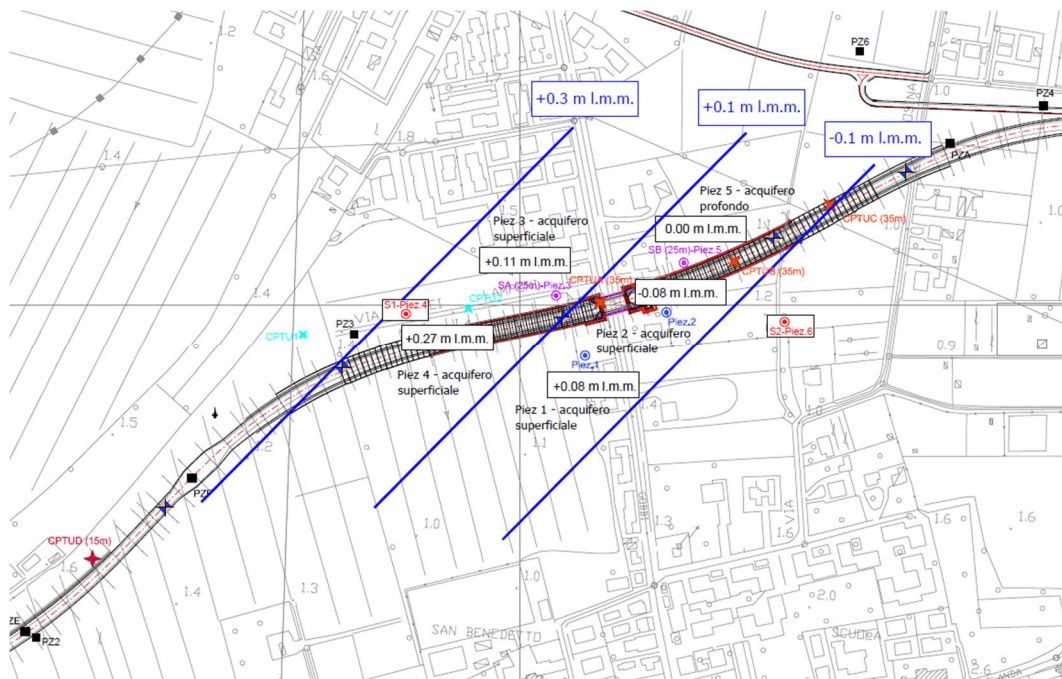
Planimetria con isopiezometriche. Riferimento lettura 8 -11- 2014
